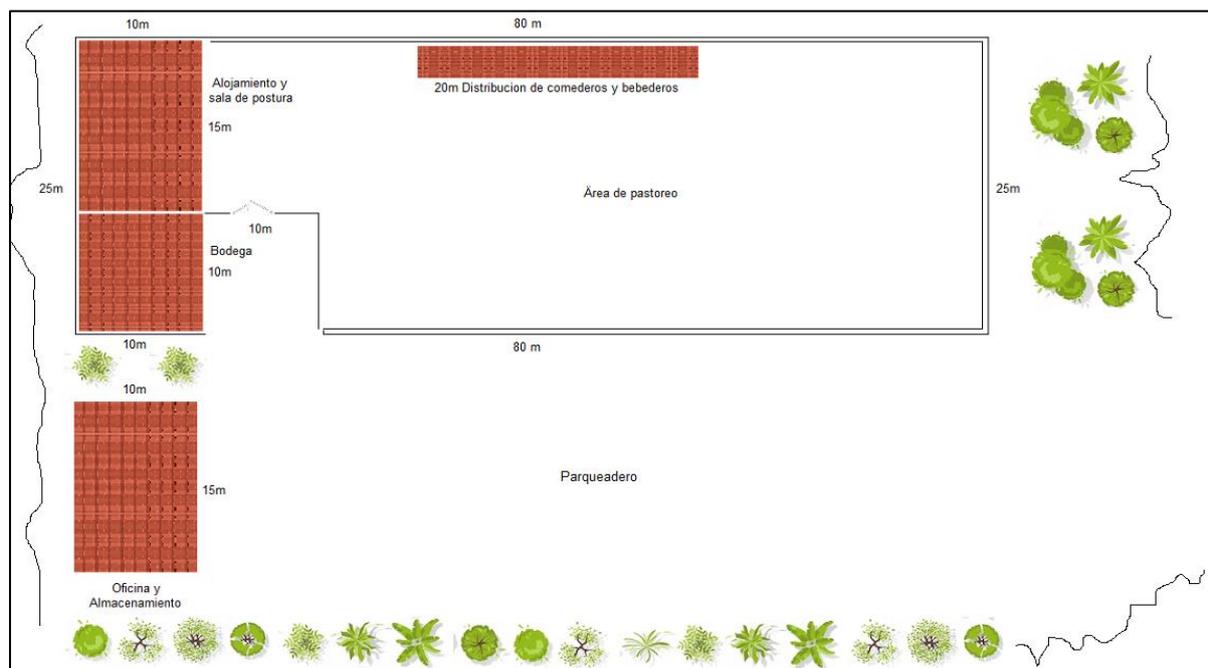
Distribución de la planta. Adaptado de: trabajo de campo. Elaborado: La autora.
